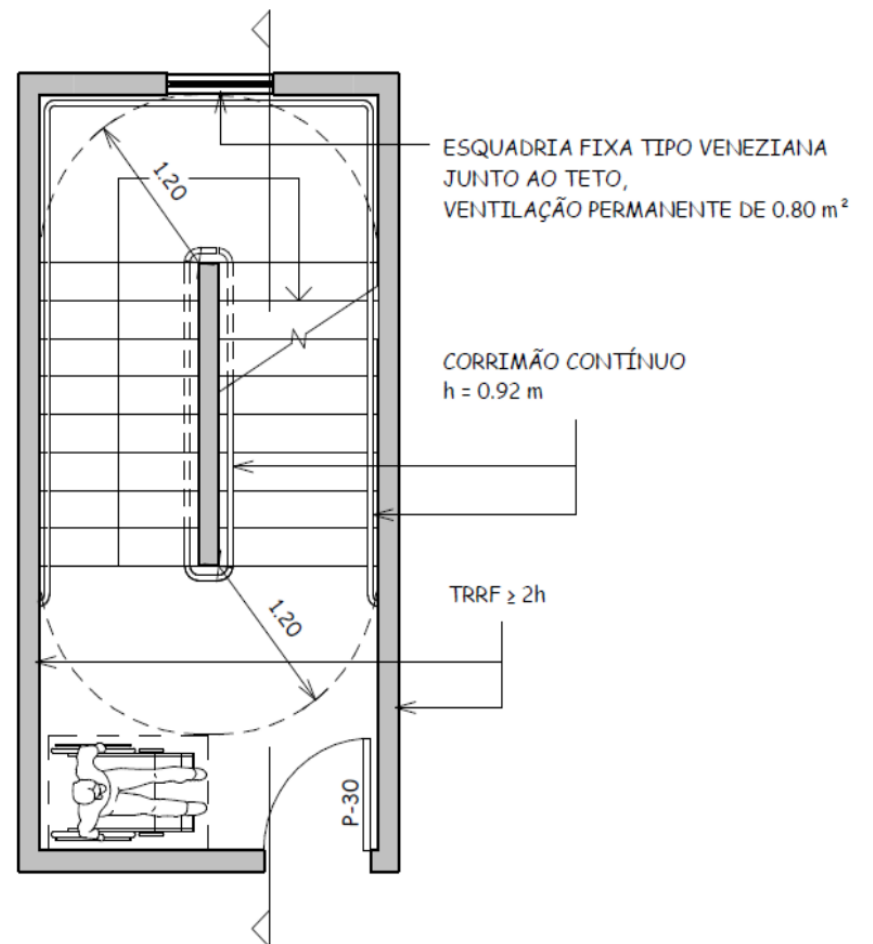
B - Escada protegida - pavimento intermediário (planta baixa).
